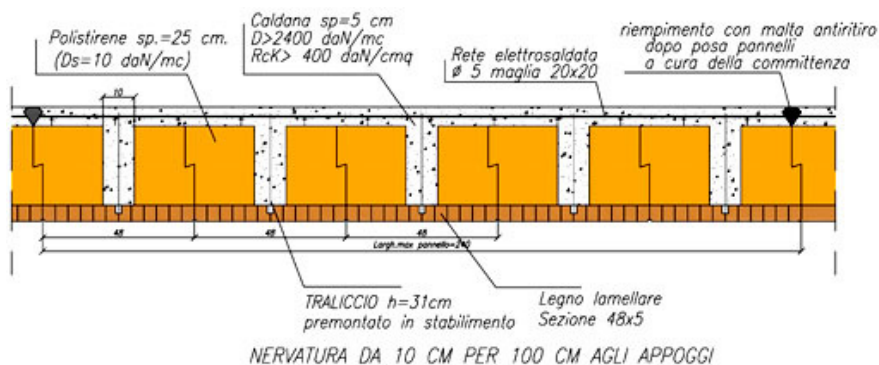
Sezione pannello Wood Beton Prepanel® Evoluzione.
